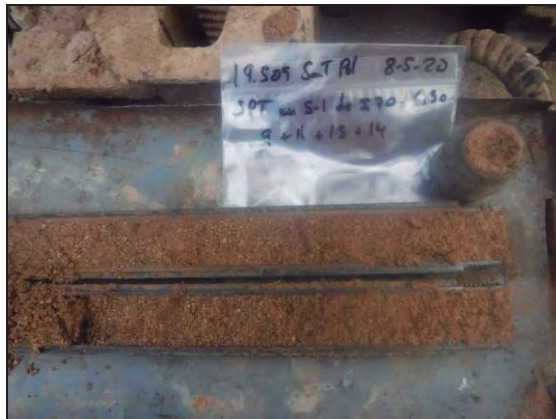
Sondeig S-1, SPT a 5,7 metres.
